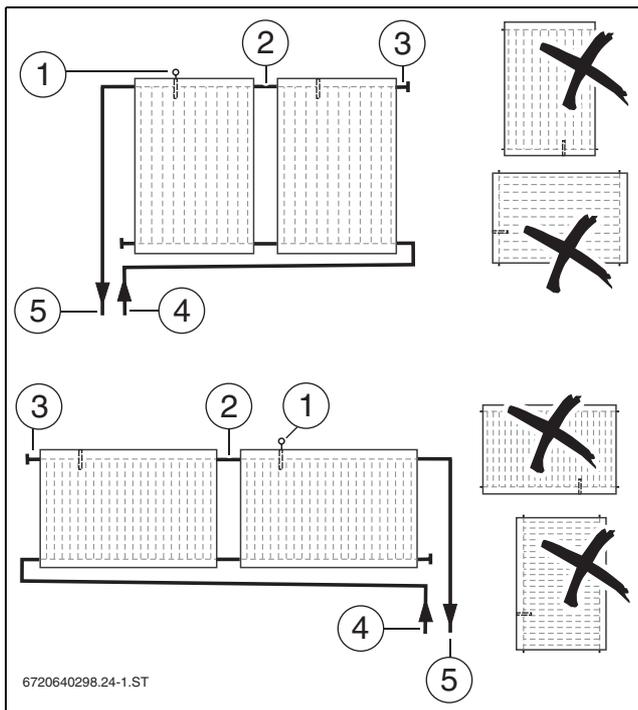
Disposição de colectores verticais (em cima) e horizontais (em baixo)
